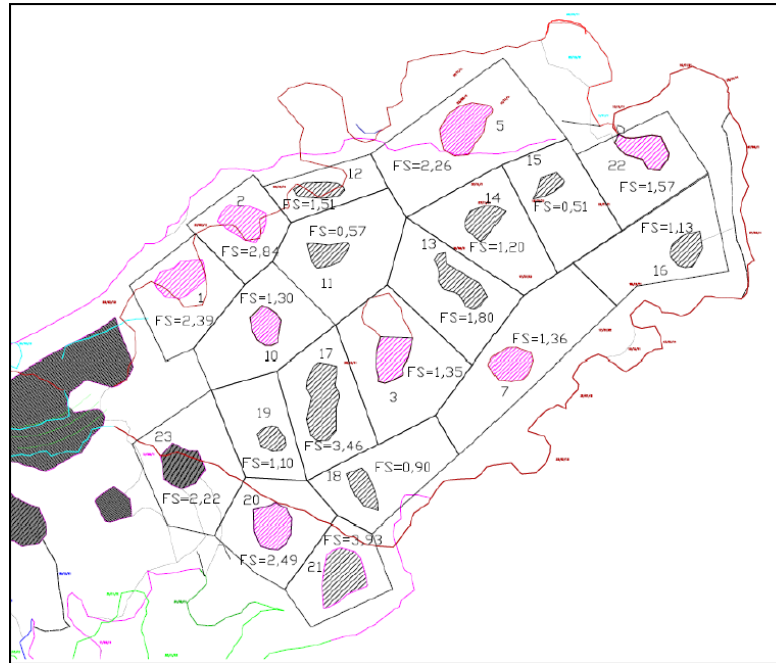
Plano de otimização do arranjo dos pilares da galeria.
